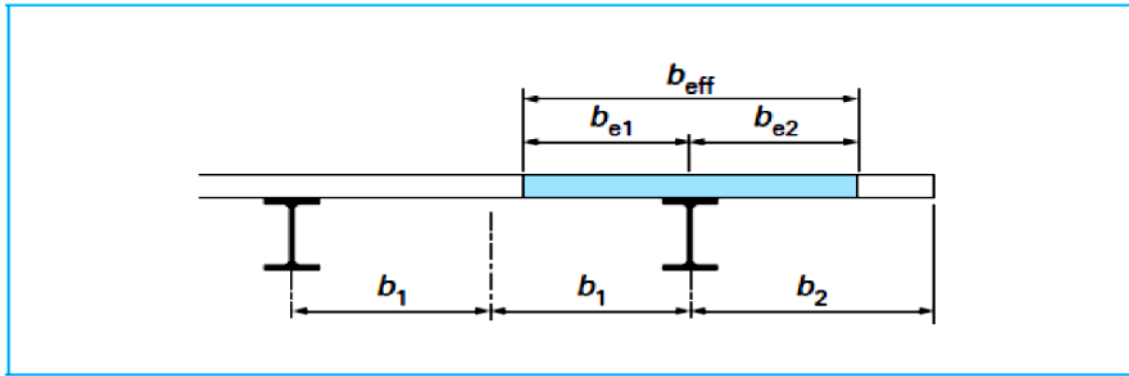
Largeur participante de dalle pour une poutre de plancher
